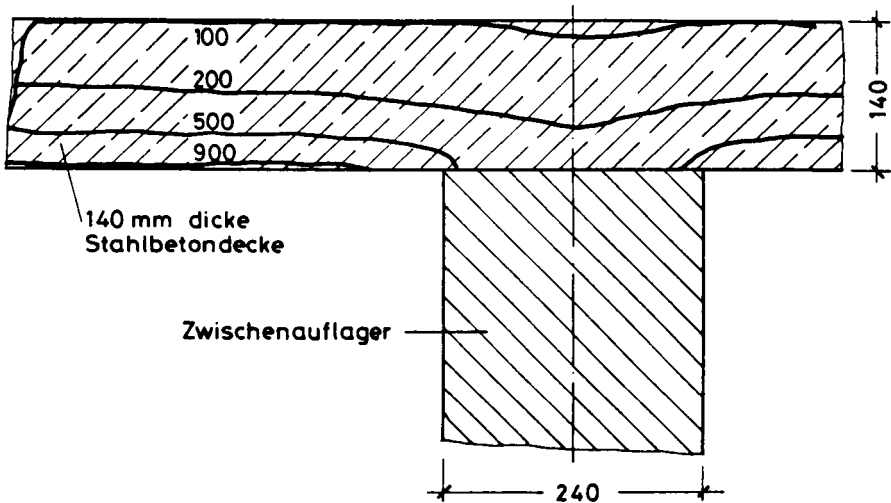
Isothermen einer Stahlbetondecke nach 90 Minuten Brandbeanspruchung
